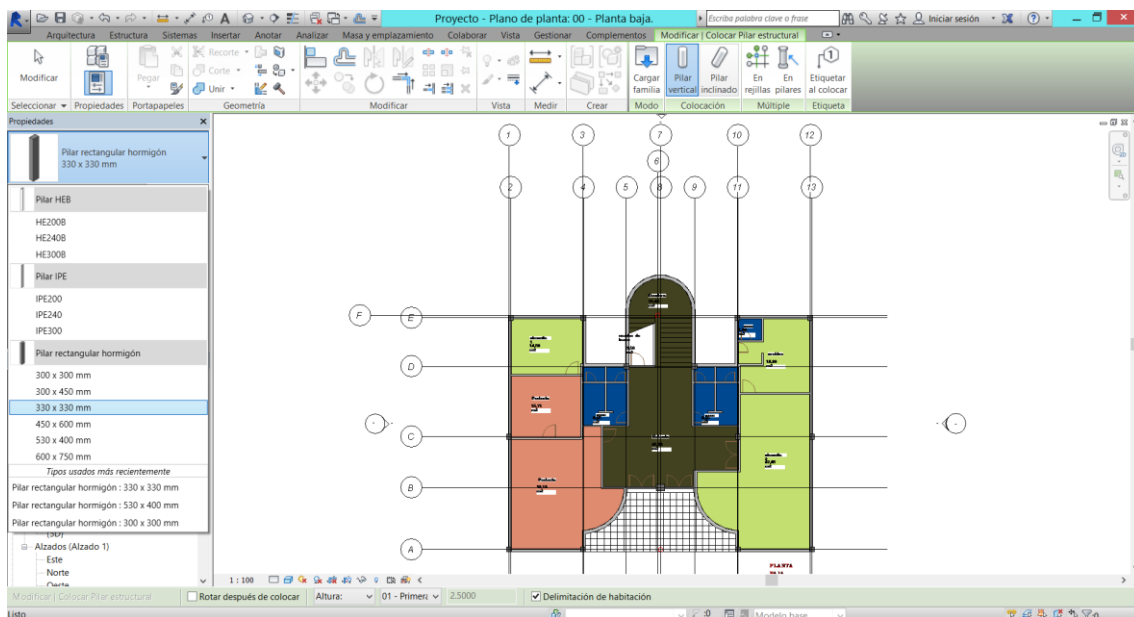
Selector de pilares estructurales. Fuente: Elaboración propia.
